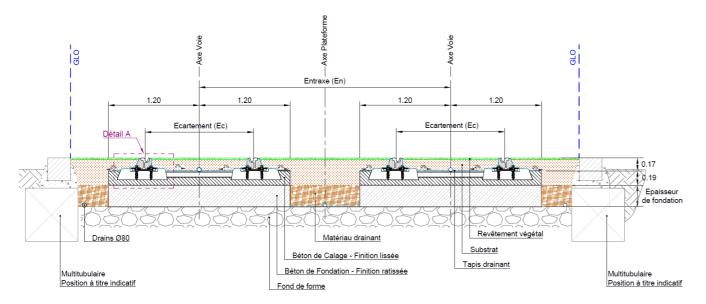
coupe type d'une plateforme - Voie béton traverses – Revêtement végétal
